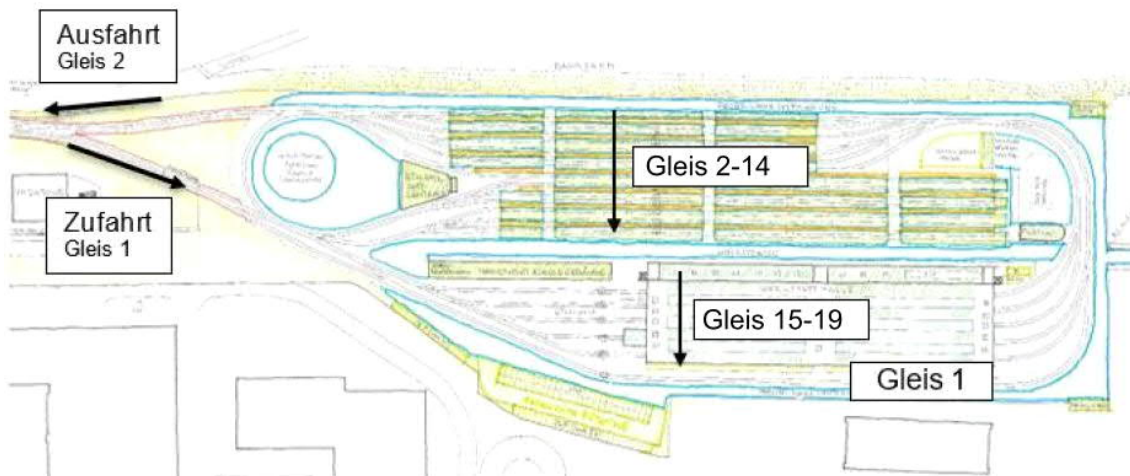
Gleisaufteilung Betriebshof (Ausschnitt Lageplan)
